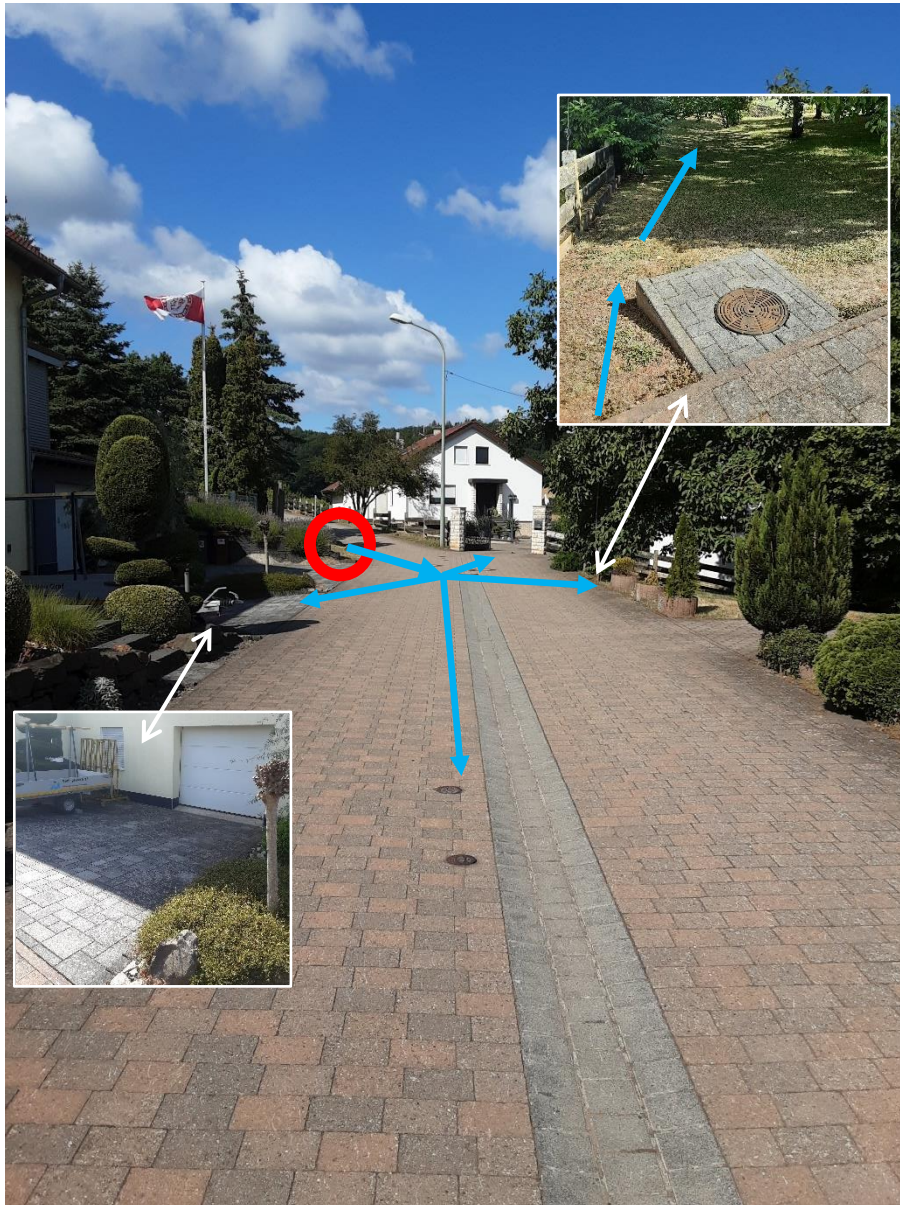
Straßenraum Waldstraße, Fließwege (blau), Einlaufbauwerk(rot) und Garageneinfahrt
